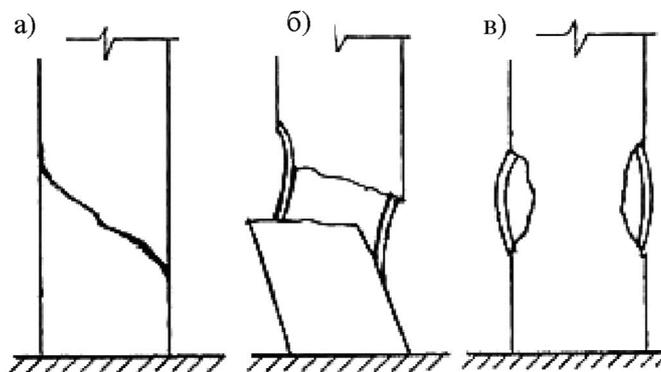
Типы разрушений железобетонных колонн: а) образование трещин; б) вырыв продольной арматуры из бетона и его разрушение; в) скалывание бетона и выпячивание арматуры
